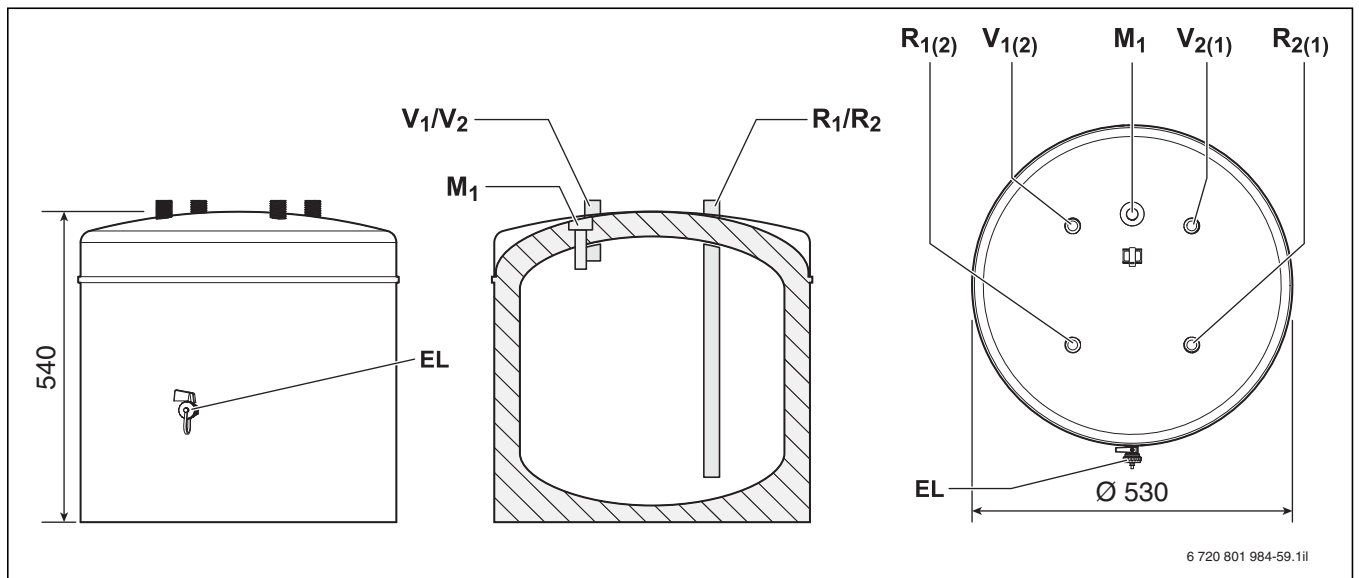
Abmessungen und Anschlüsse Pufferspeicher P50 W (Maße in mm)
